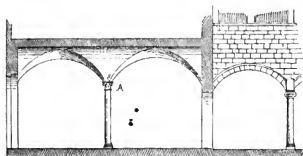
Coupe sur le rez-de-chaussée du palais Gambacorti.
